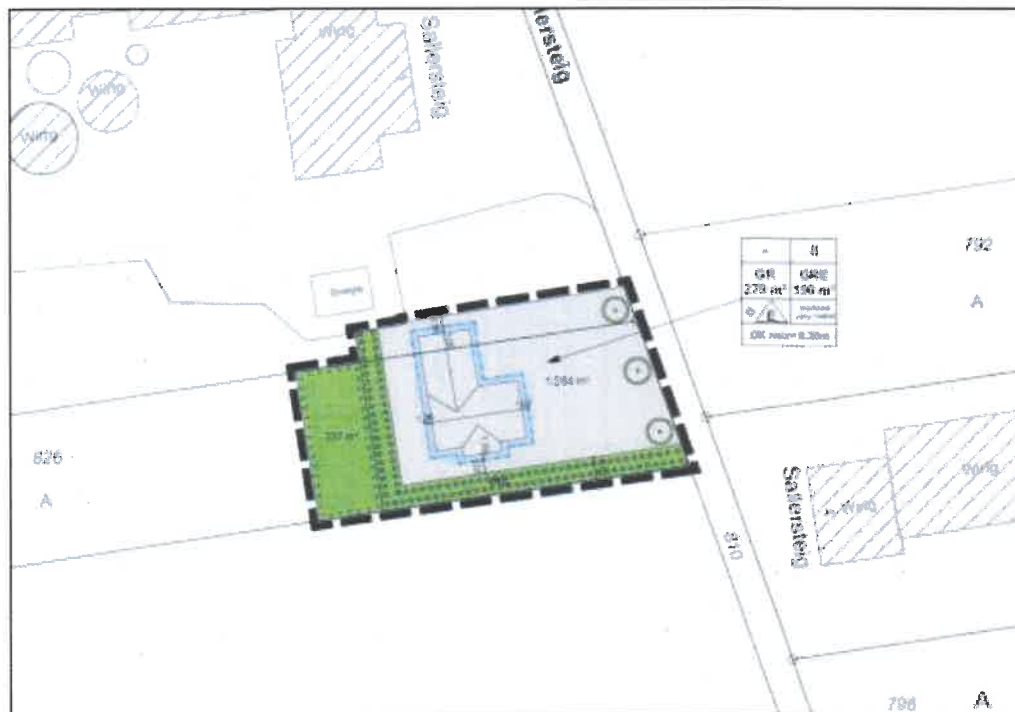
Geplante Wohnbebauung im Gewann Sallersteig nördlich von Wippingen.
